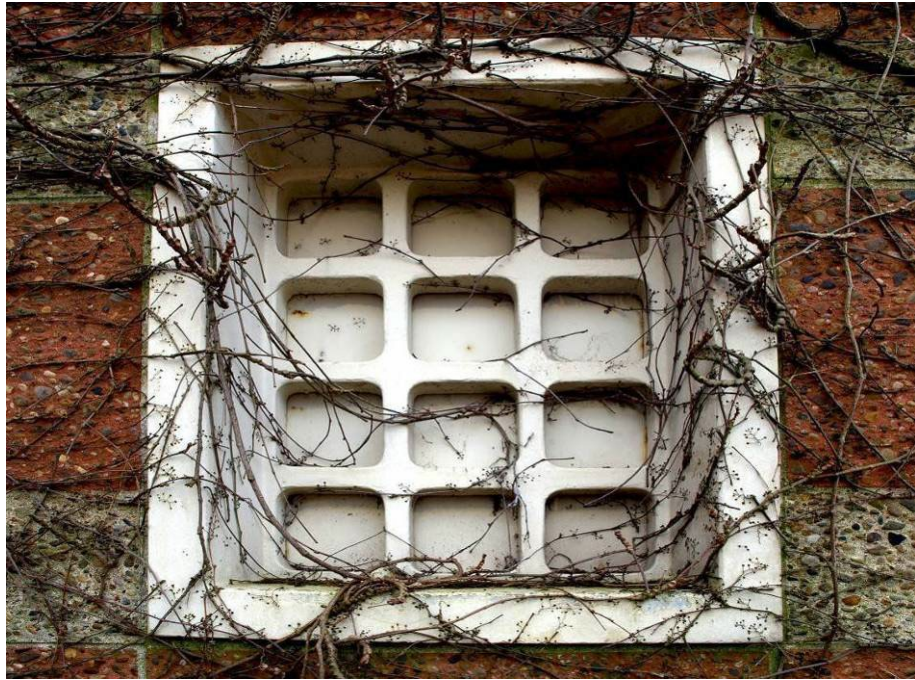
In het detail toont zich de meester: betonnen raamkozijn en stalen balkonhekje.
